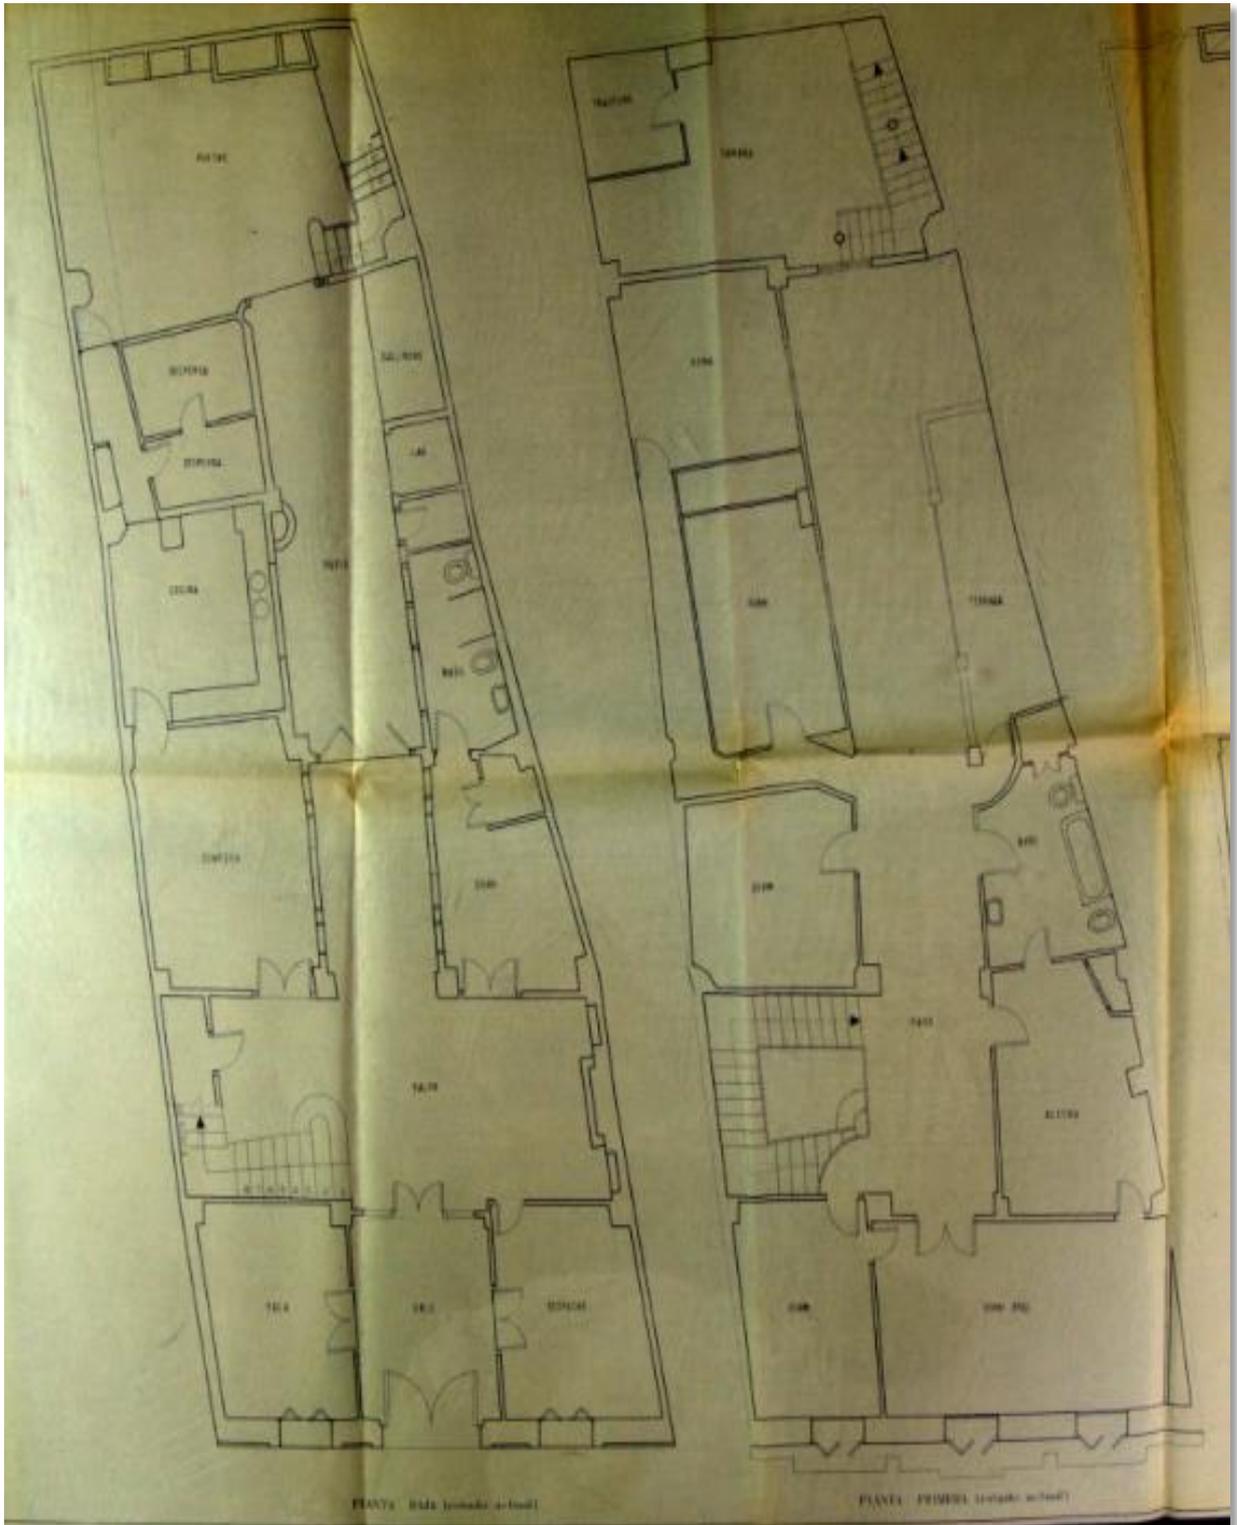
Plano de planta baja y planta primera. Estado 1948.
